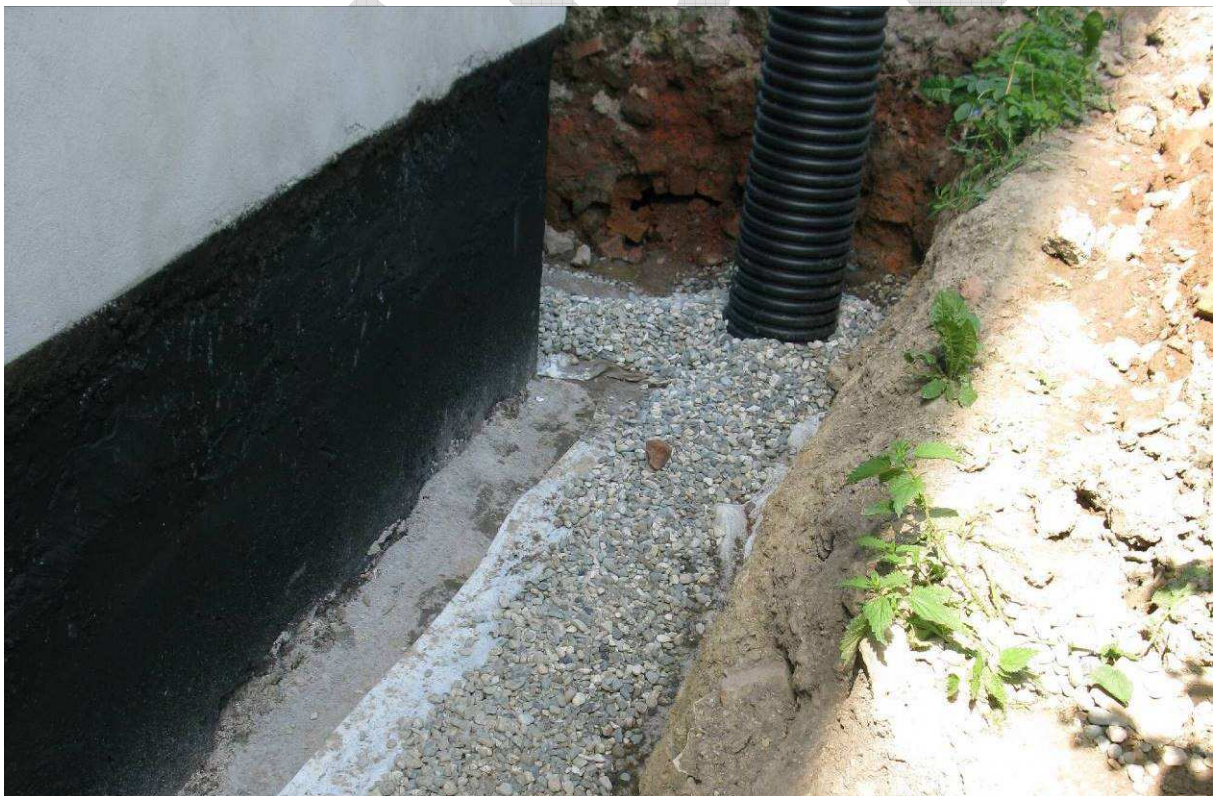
Wykonywanie pionowej hydroizolacji bitumicznej na ścianach piwnic
